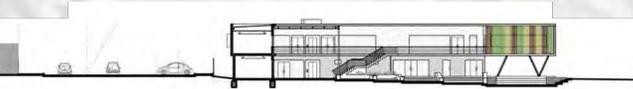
Elevación arquitectónica Interior Centro Cultural Alto hospicio.
